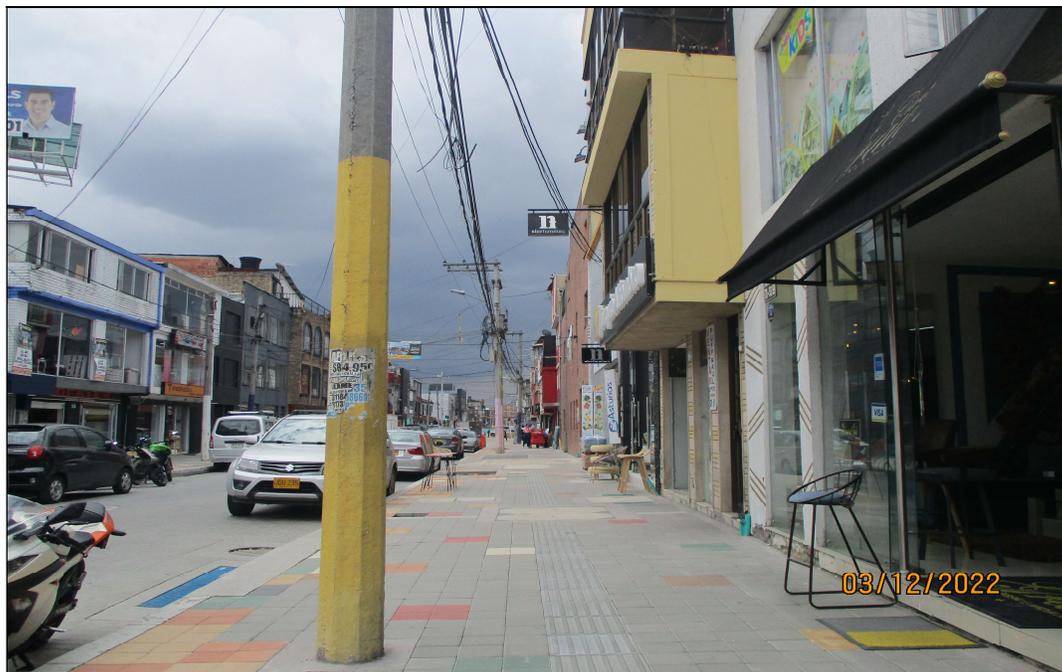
Anden oriental al Sur. Foto No. 5: Anden occidental del predio vista al sur. Foto No. 6: Perfil Vial y alturas edificaciones
